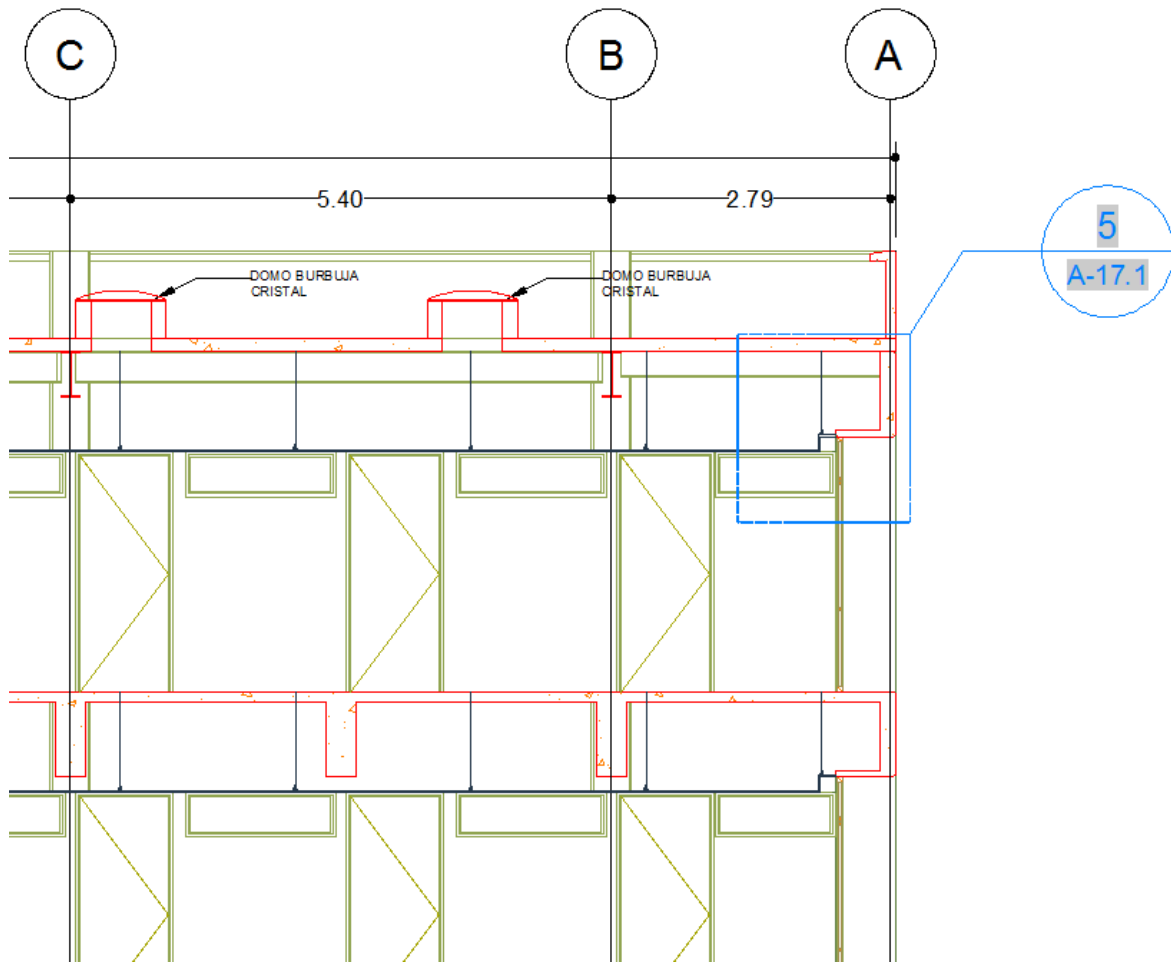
localización de detalle en Corte Longitudinal 1-1
